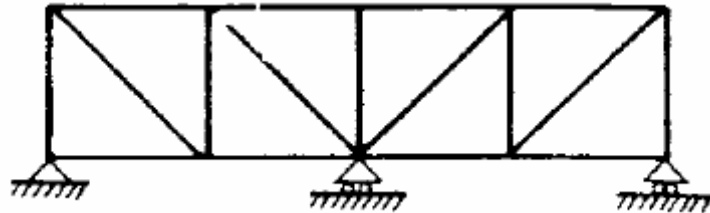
Esquema de la Viga Pratt hiperestática
